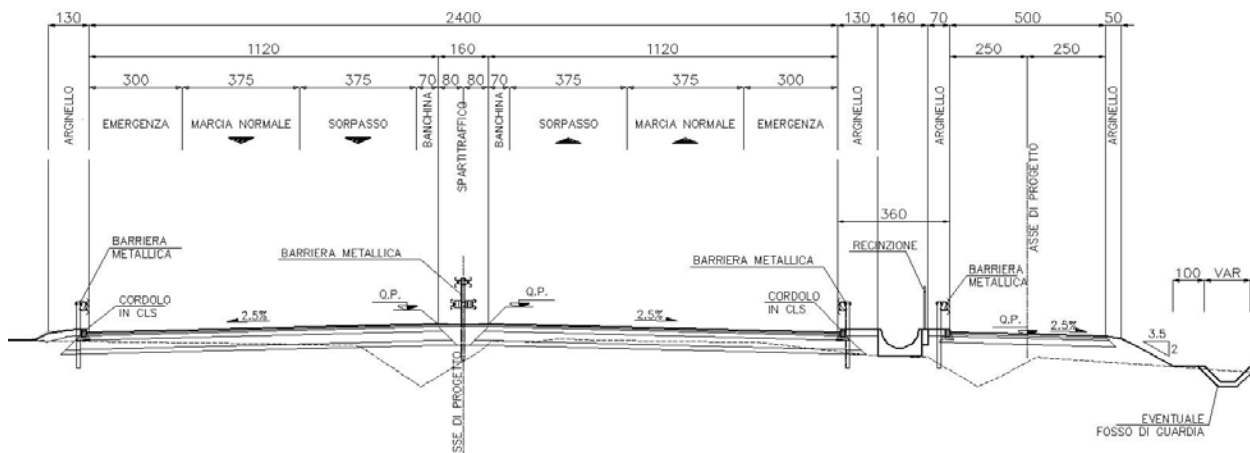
Sezione tipo di progetto con viabilità secondaria in complanare (adeguamento SS1 Aurelia)
